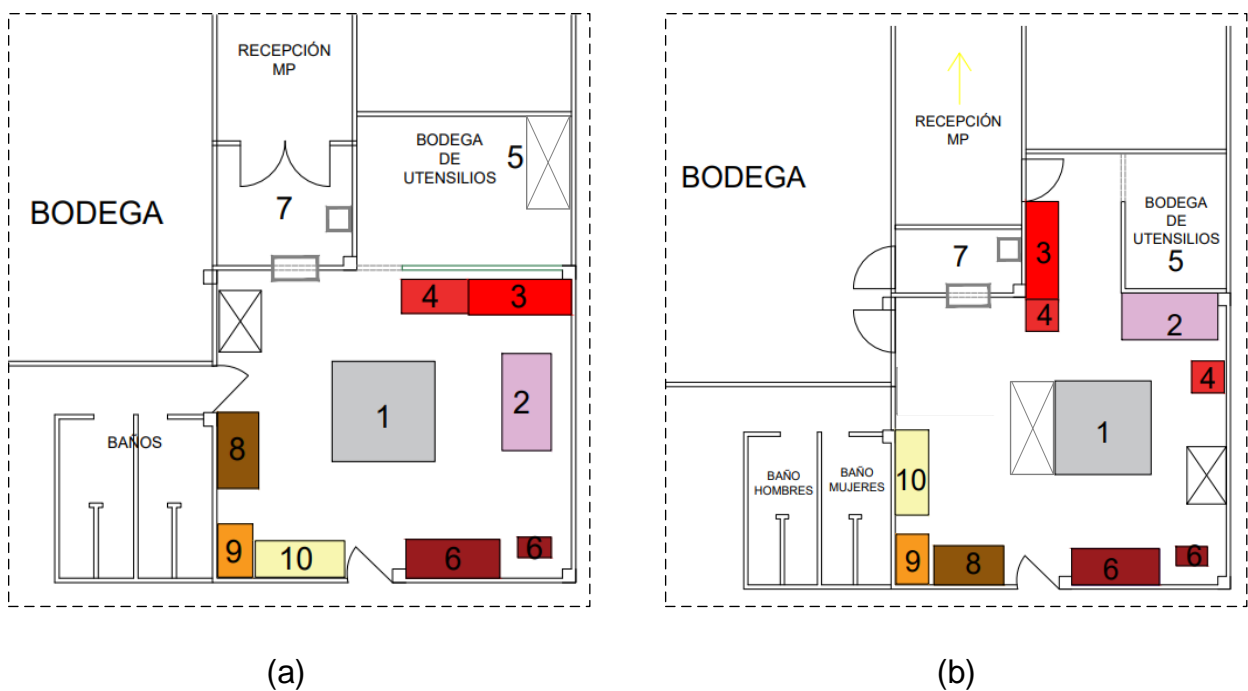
a) Propuesta layout de baja inversión b) Propuesta layout final [Fuente: Elaboración Propia]
